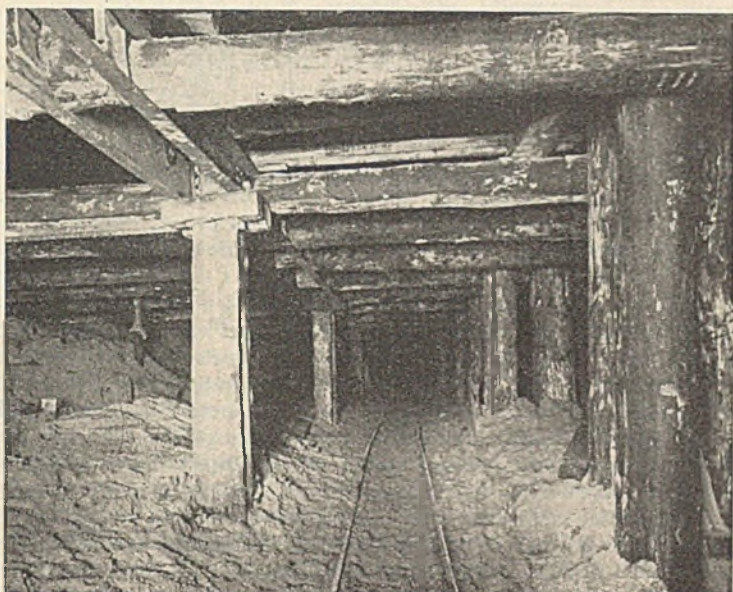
Durchsteifung der Triebbladen auf Baugrubensohle.
